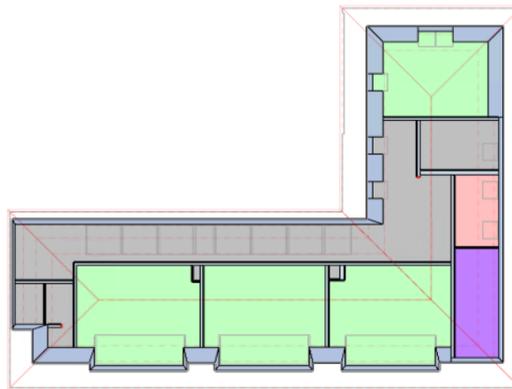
Grundriss Dachgeschoss, zoniert
